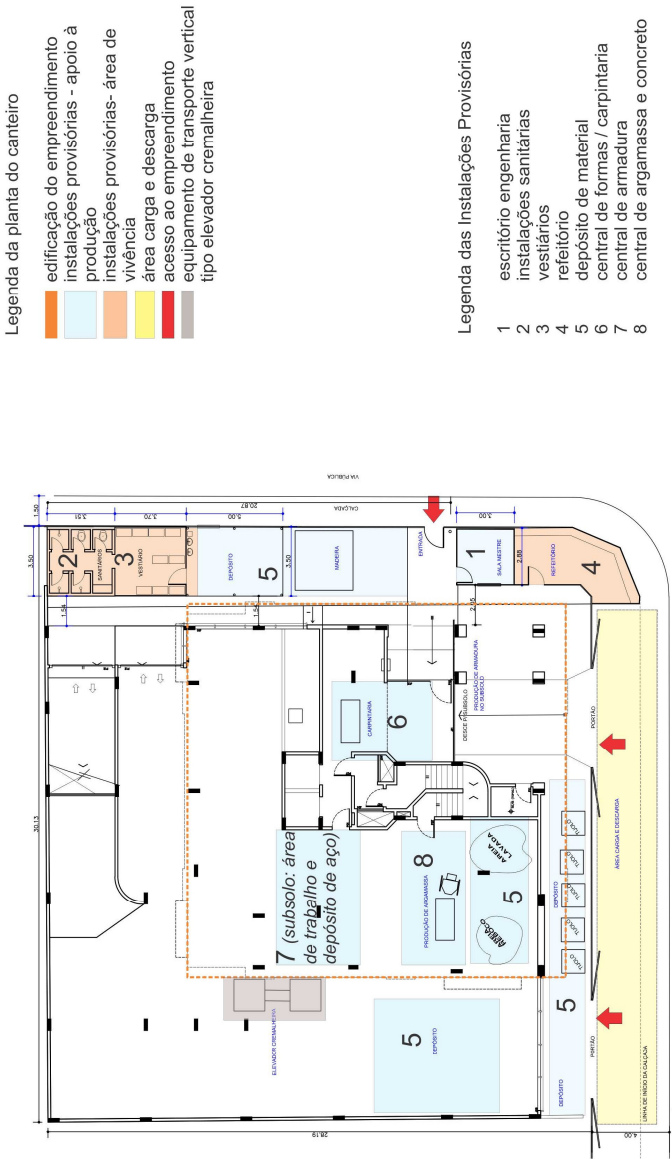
Projeto do canteiro de obras do estudo de caso C.
